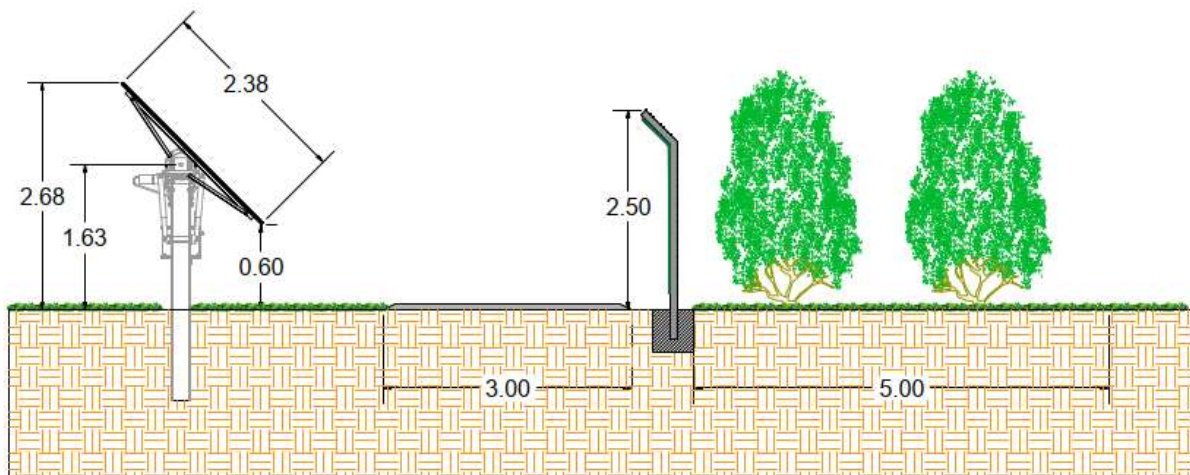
Estratto elaborato FAB.ENG.TAV.048.00_Planimetria, sezioni e dettaglio degli interventi di mitigazione abbagliamento – particolare mitigazione esterna alla recinzione
